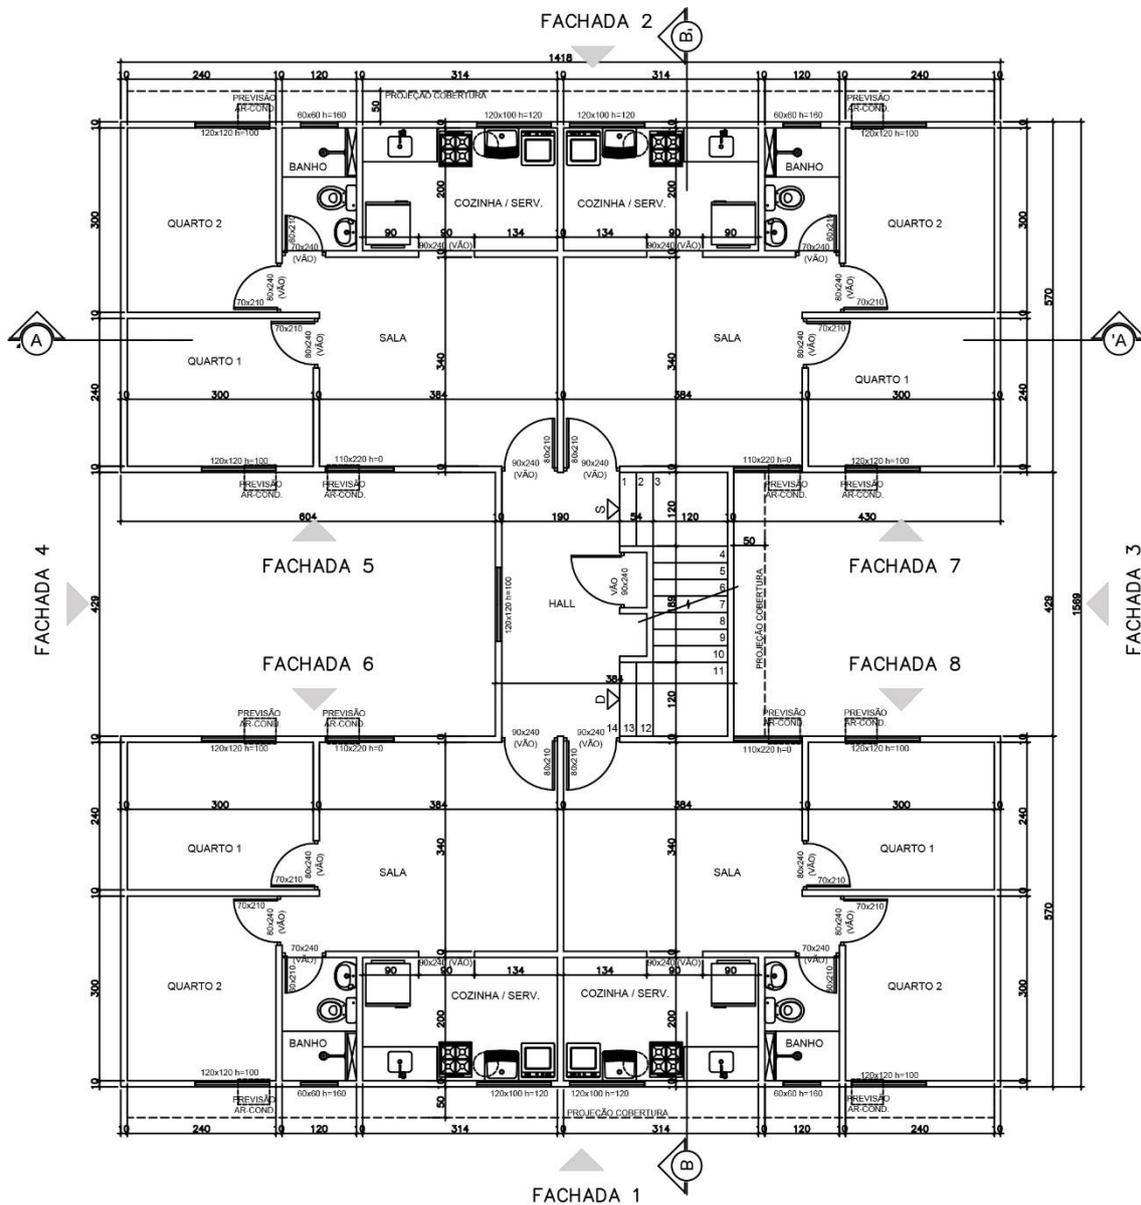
Planta do pavimento tipo do protótipo padrão estudado. Fonte: Arquivo disponibilizado pela construtora.
